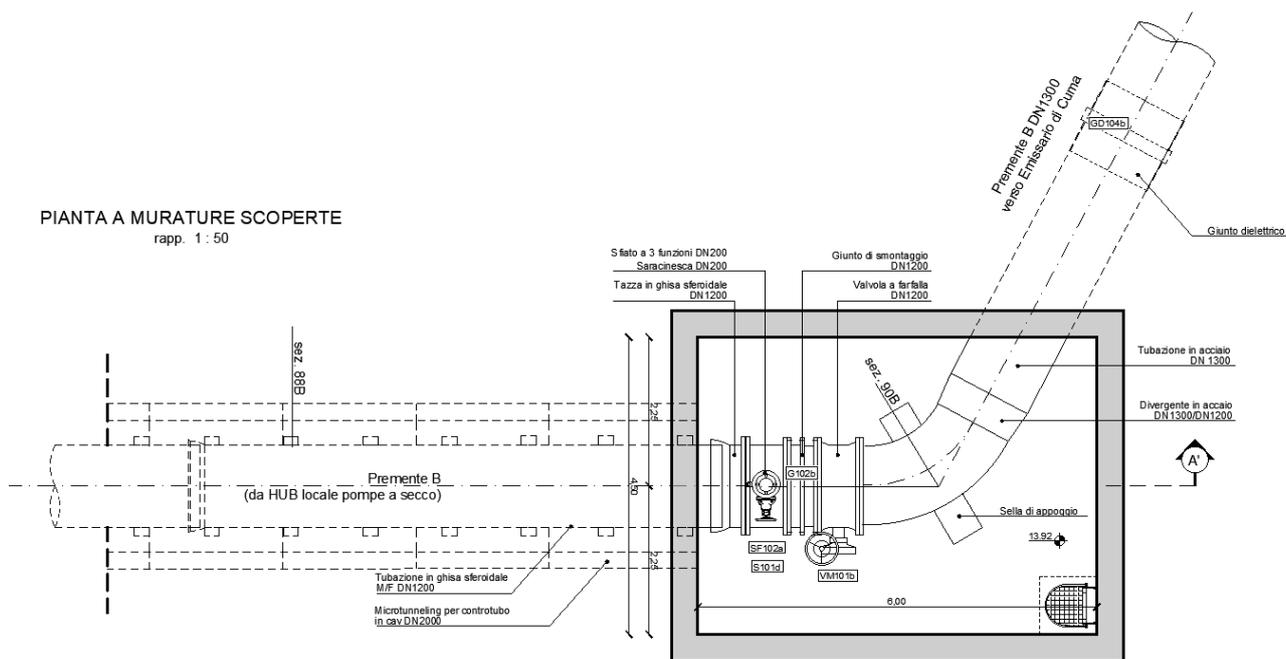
Microtunnel – Camera di arrivo: Pianta
